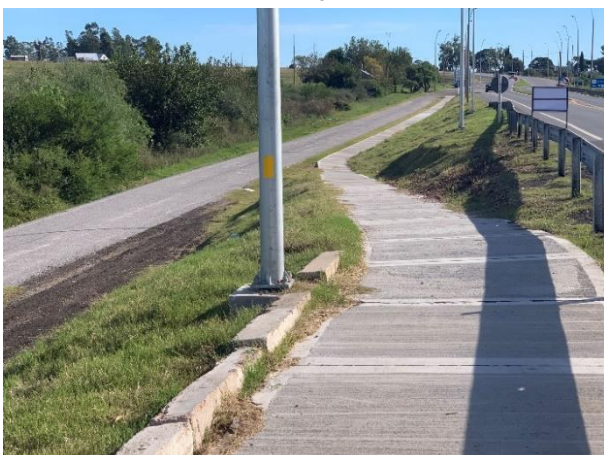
, Tramo terminado. Ciclovía instalada. Faja pública con buena cobertura de tapiz vegetal.
